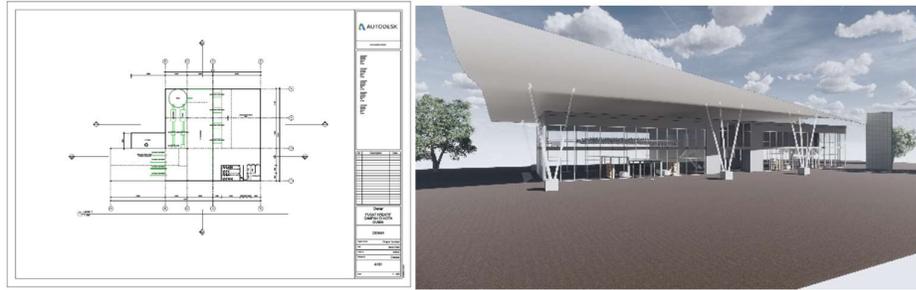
Denah dan tampak pabrik plastic dan Pabrik Kompos
